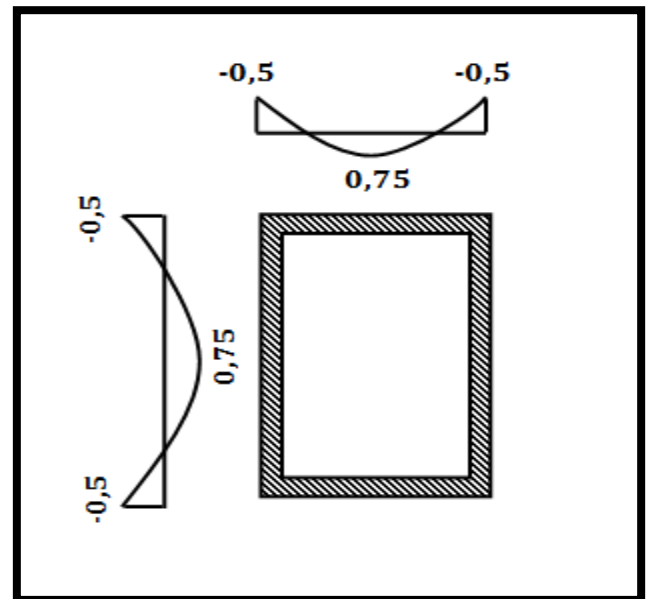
schéma statique du mode d'encastrement du panneau
